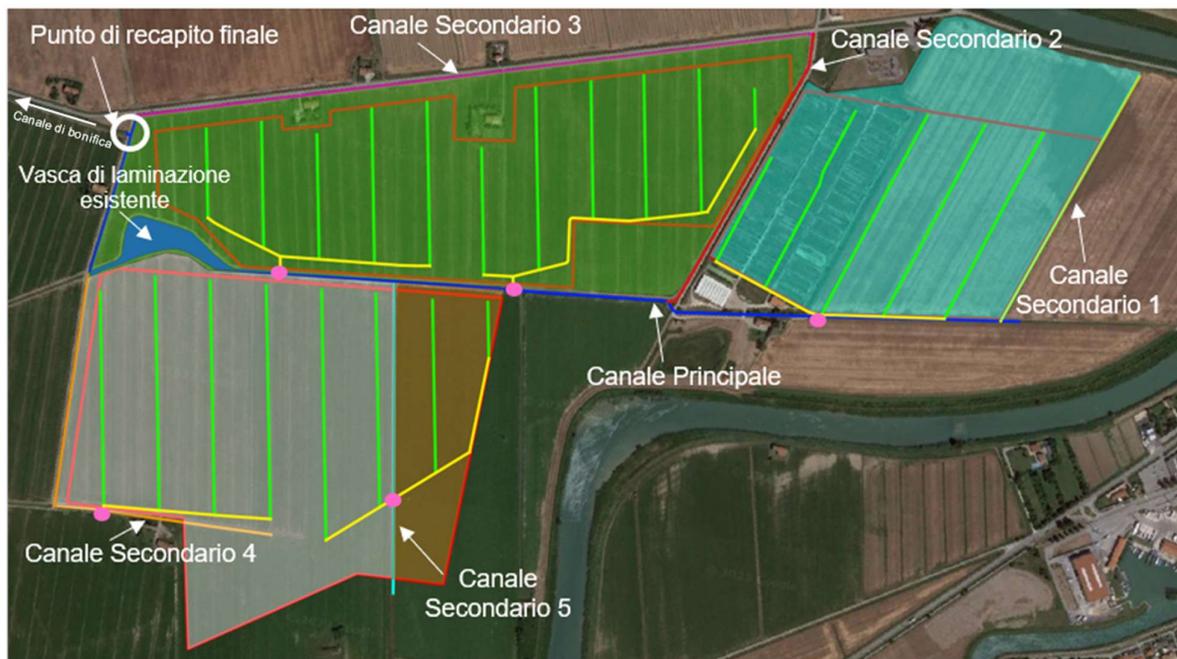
Schematizzazione del sistema di drenaggio dell'area di impianto in progetto
